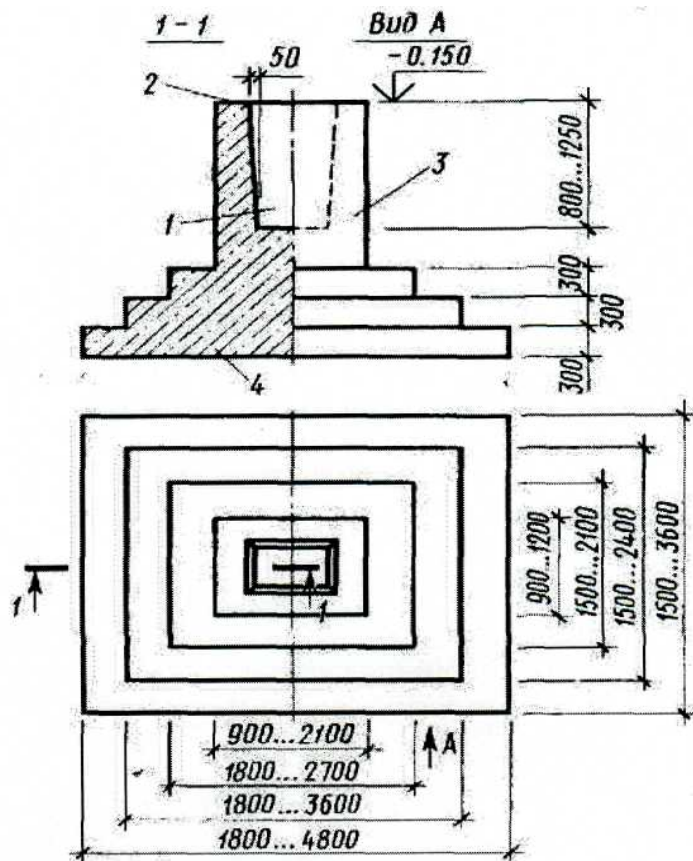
Железобетонный монолитный фундамент стаканного типа [23]:
